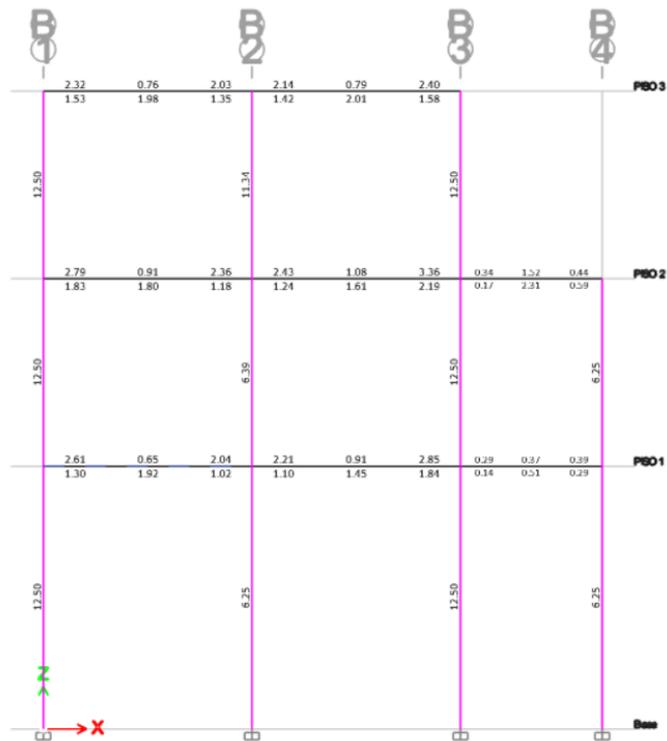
Área de acero en columnas, Pórtico C-C
